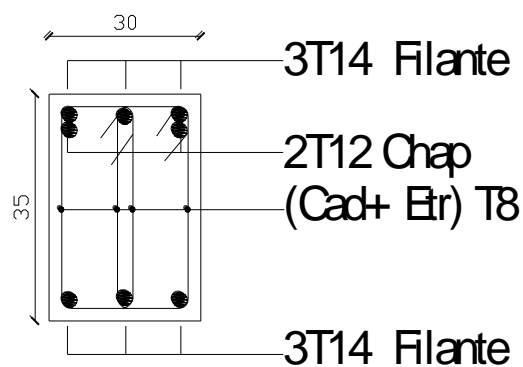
Ferraillage sur appuis d'une poutre principale.
